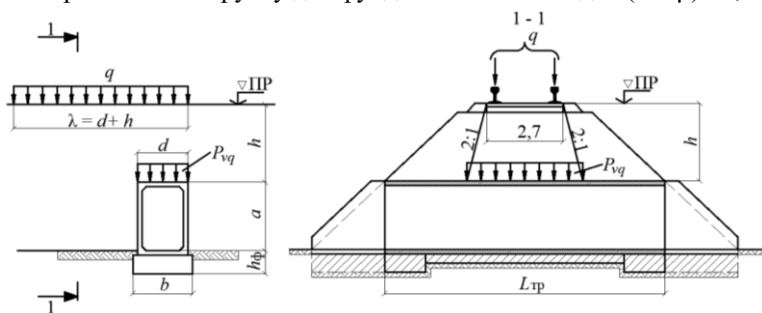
Схема к определению расчетного вертикального давления на звенья трубы от временных нагрузок
